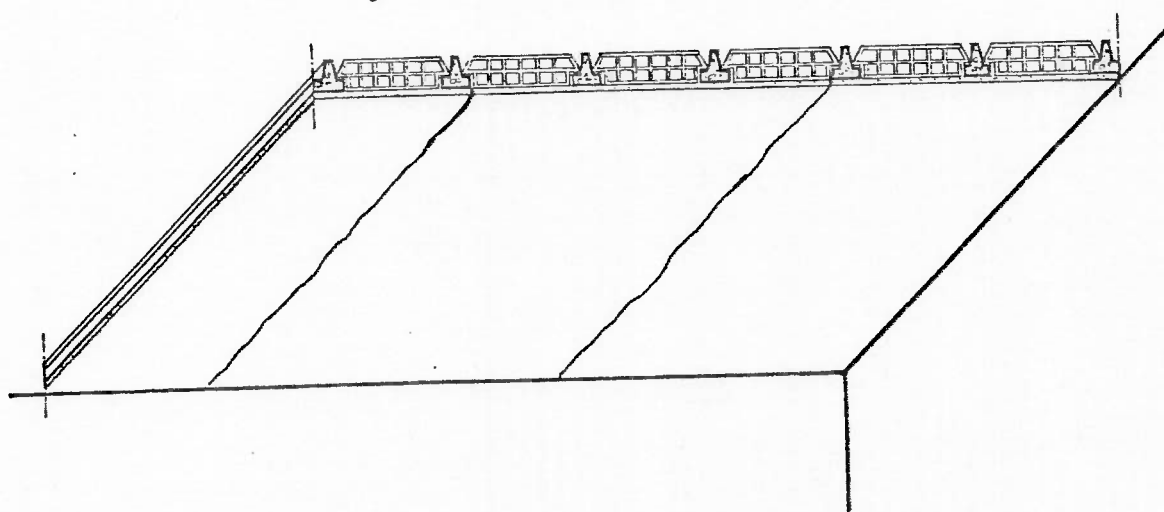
Fissuras provocadas por movimentações térmicas em forro constituído por laje mista
